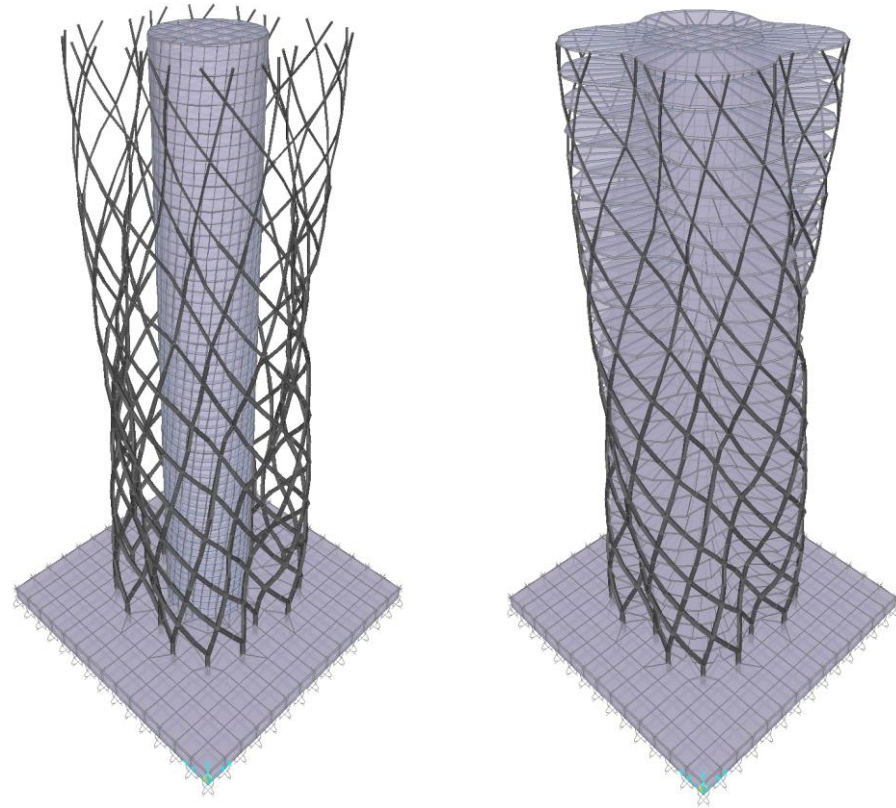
En la imagen de la izquierda podemos apreciar tanto el tubo interior de hormigón como el tubo exterior formado por entramado de barras metálicas, en la imagen de la derecha se pueden apreciar los forjados como se apoyan en ambos tubos
